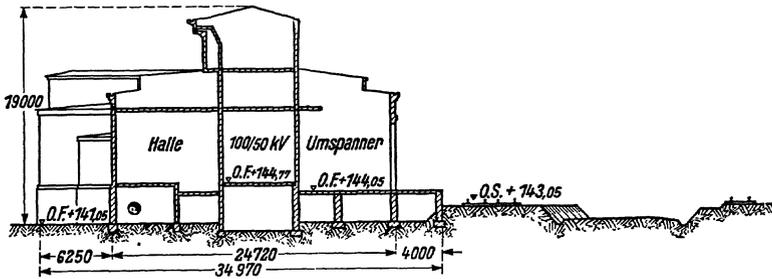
Anlagenschnitt A—B nach dem Lageplan.
